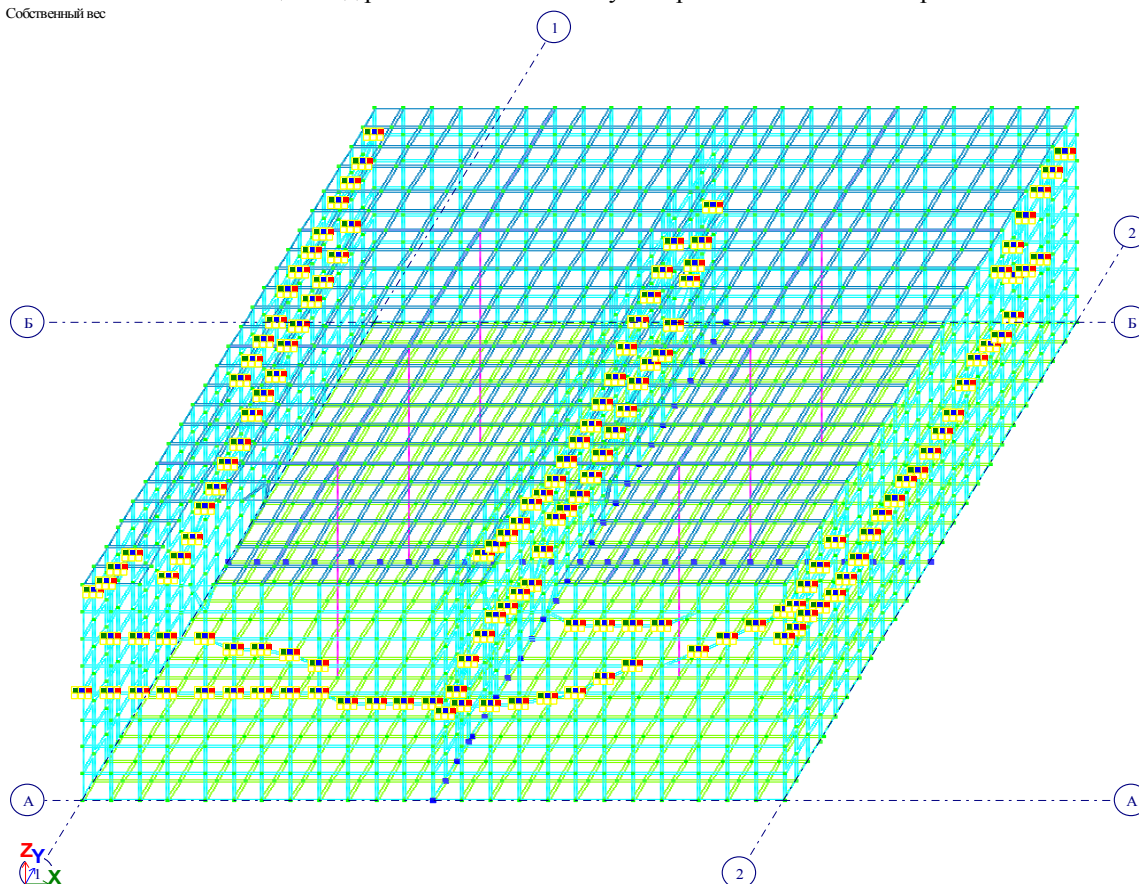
Общий вид расчетной схемы с учетом рабочих швов бетонирования
